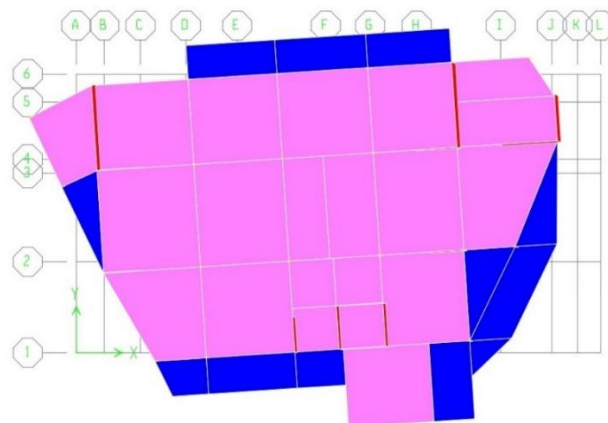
Mode 1 translation sur x (vue en plan)
